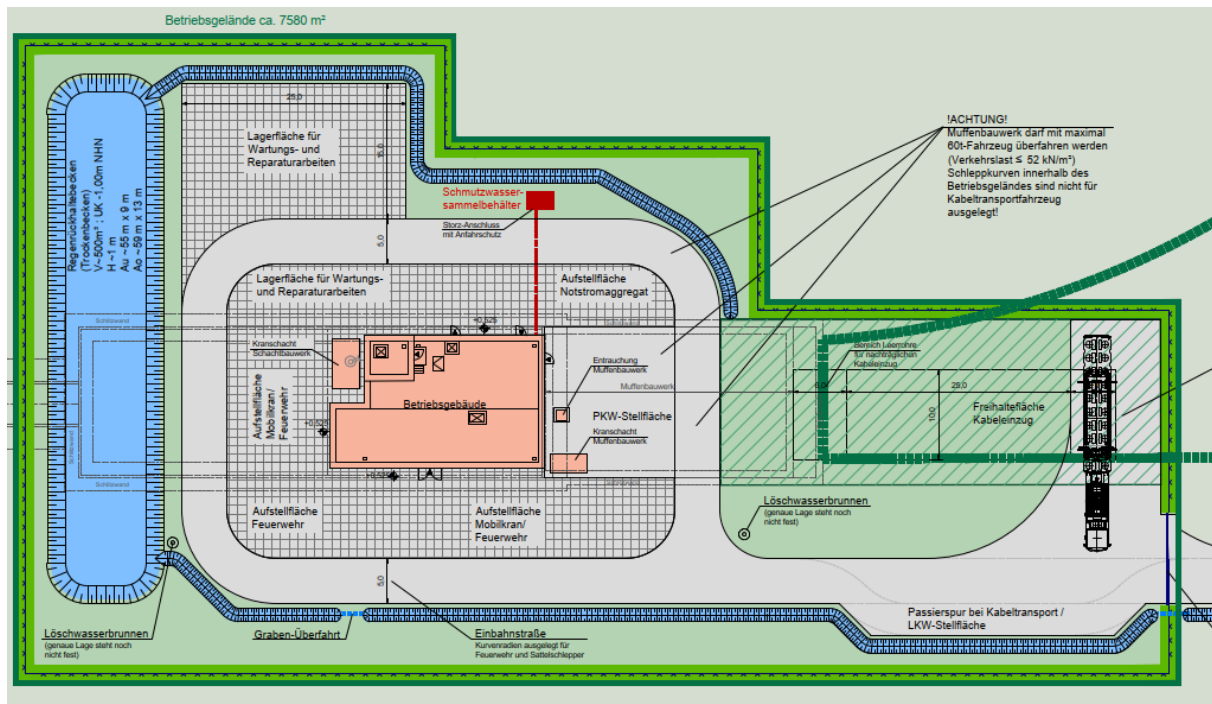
Detailplan Betriebsgelände SH (Auszug aus Teil F1.1.3.3)
